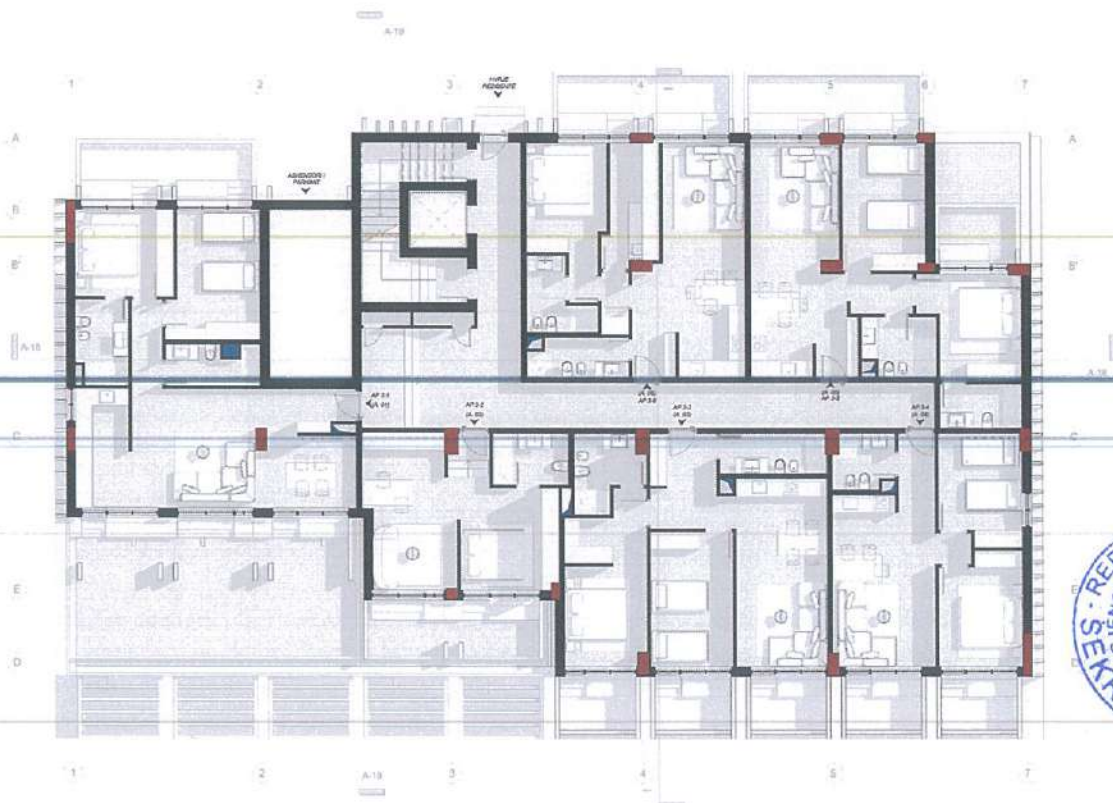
Planimetria e mobiluar e katit +3 South Hotel
